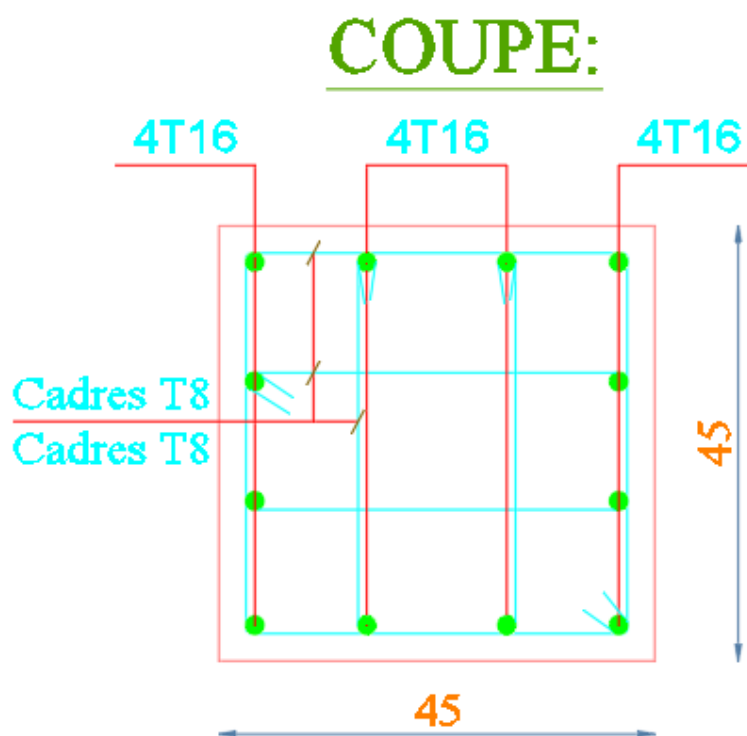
Schéma du ferrailage du poteau (45x45) cm²
